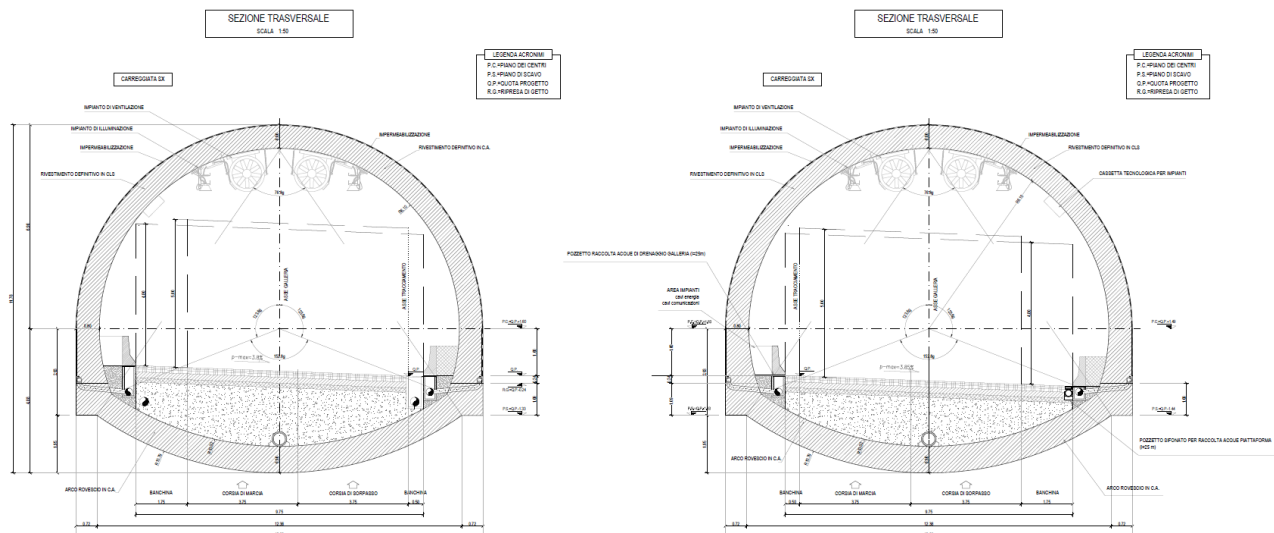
Sezione tipo corrente galleria “Le Ville”
